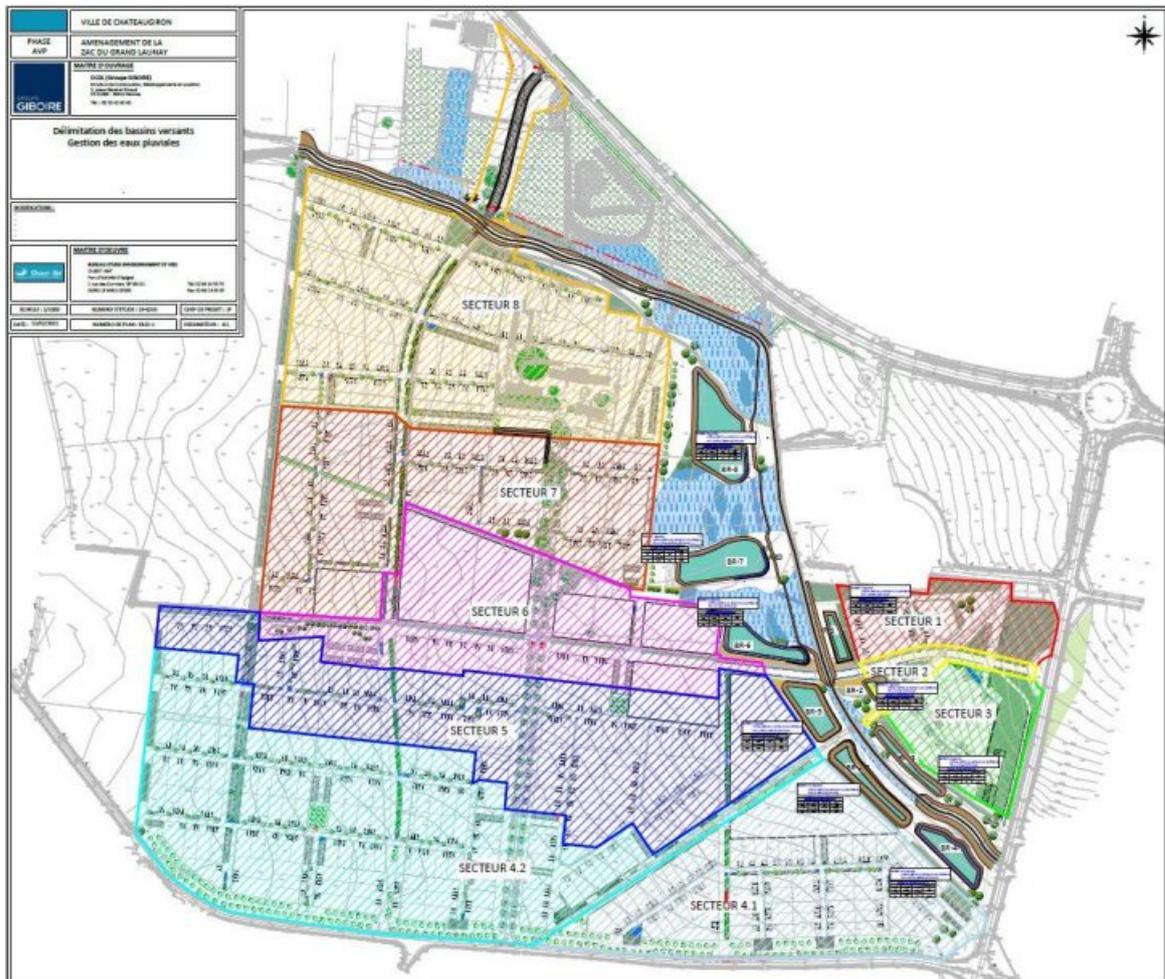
plan au stade de l'avant-projet des bassins versants collectés
